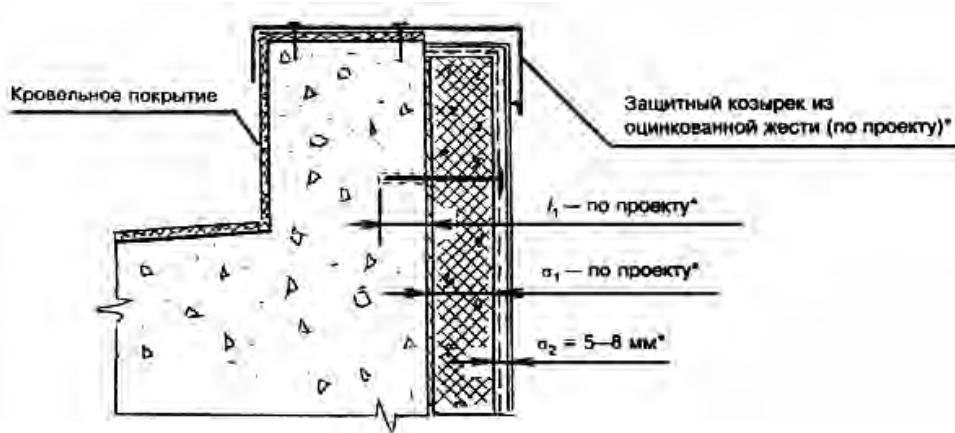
Примыкание теплоизоляционного слоя к парапету в верхней части фасада
